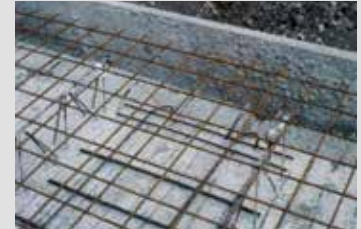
Obere Bewehrung und Fugenstoßbewehrung
